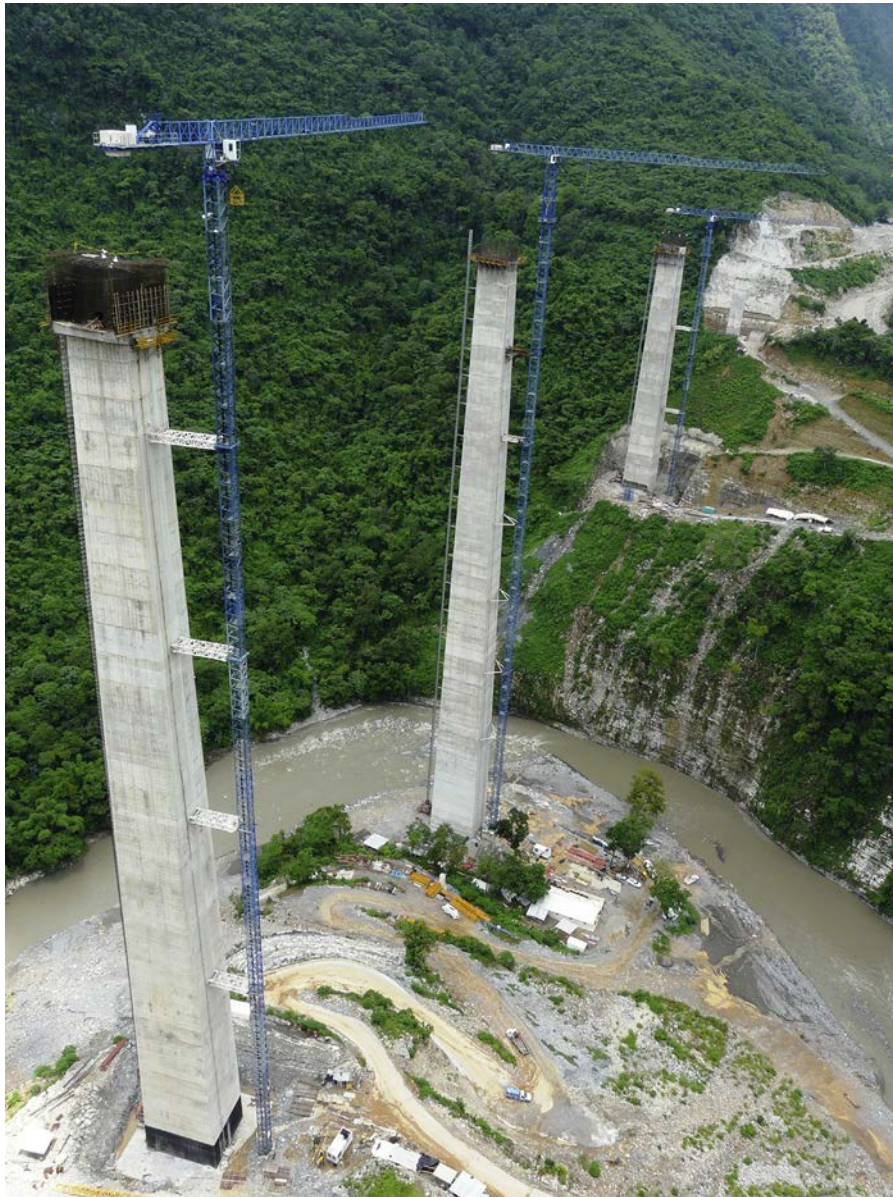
Vista general de las pilas 3, 4 y 5 terminadas.
